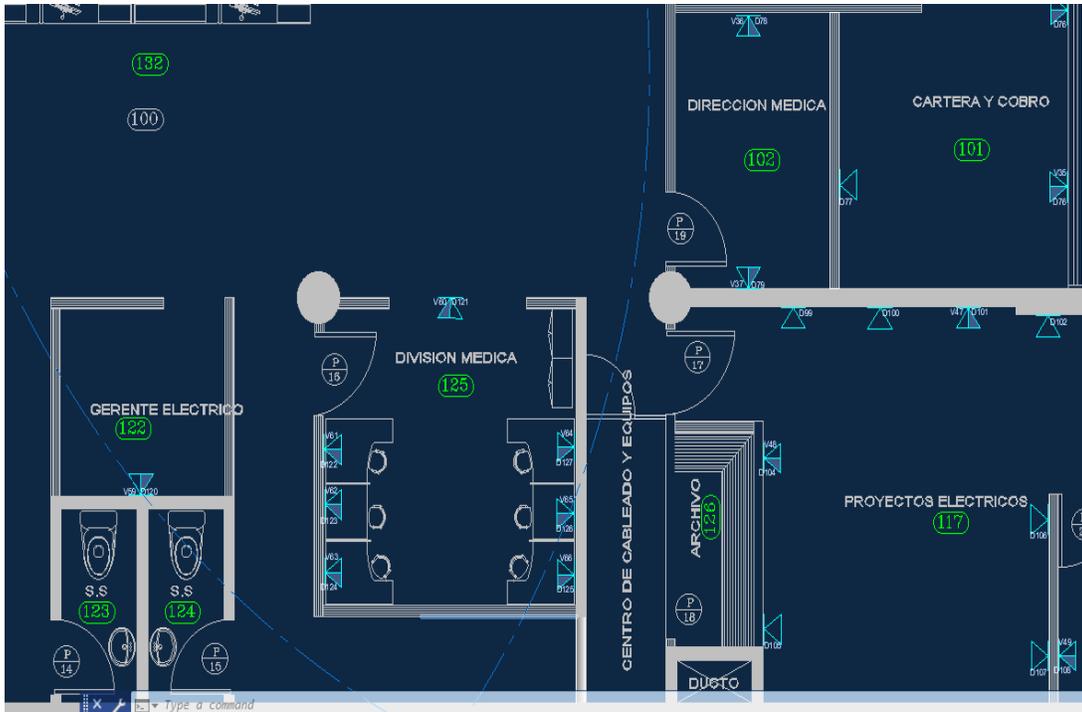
Ubicación actual del centro del cableado y equipos, planta baja. Planos de infraestructura de sinter S.A
